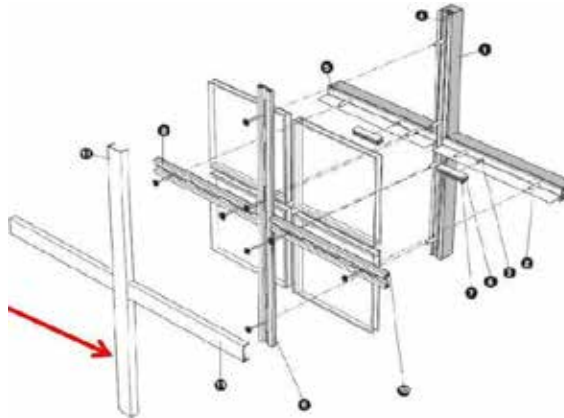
Detalle del muro cortina. Fuente: http://img.archiexpo.es/images_ae/photo-g/51651-2134979.jpg. (2016)
